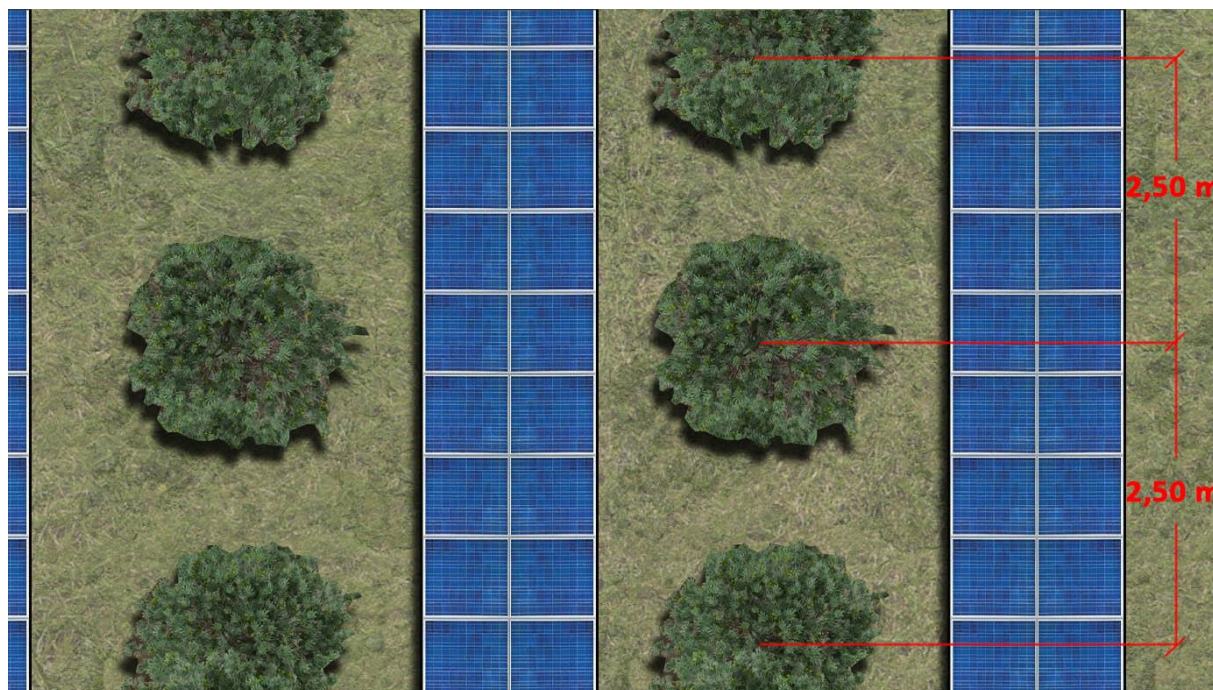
Tipologico – Vista Planimetrica dell'impianto Olivicolo.
